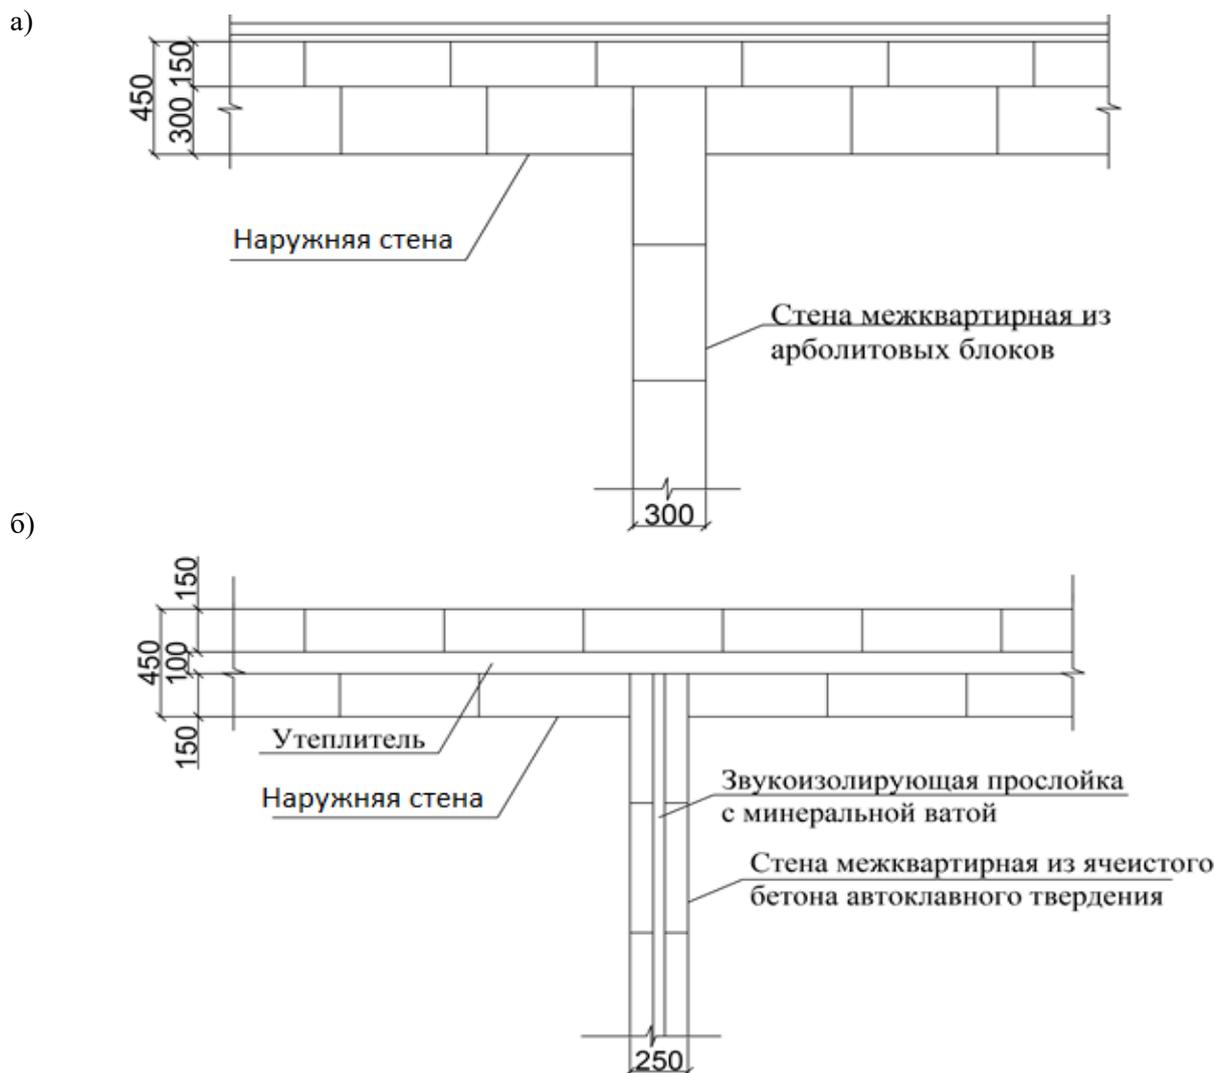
Узлы примыкания внутренних и наружных стен, выполненных:
